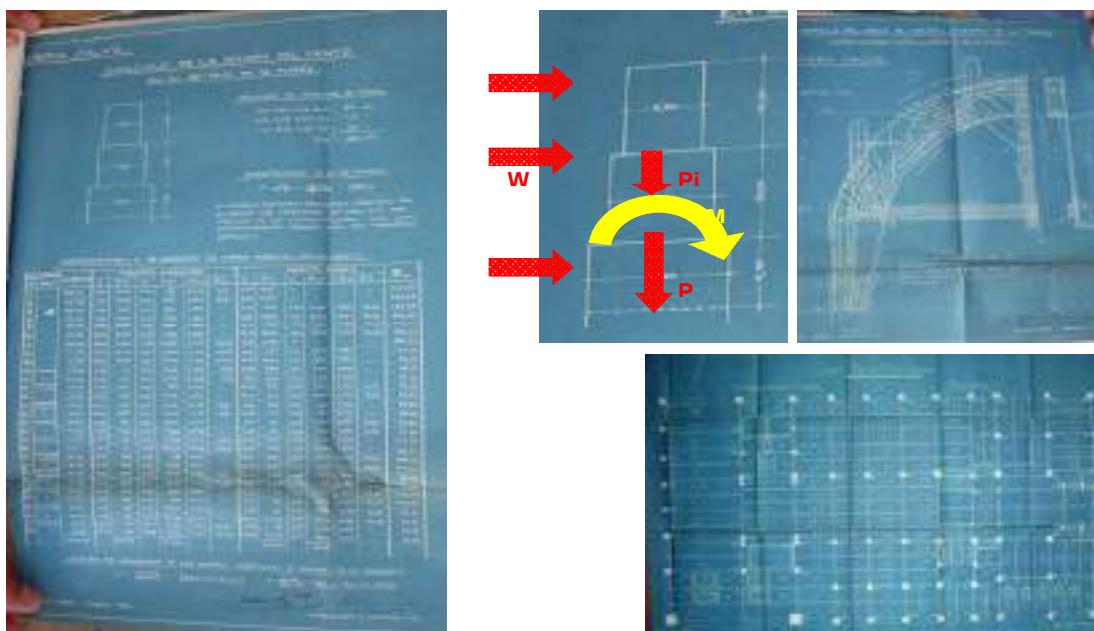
Planos de estructura en el cambio de ubicación de pilares y cálculo del viento de la torre
